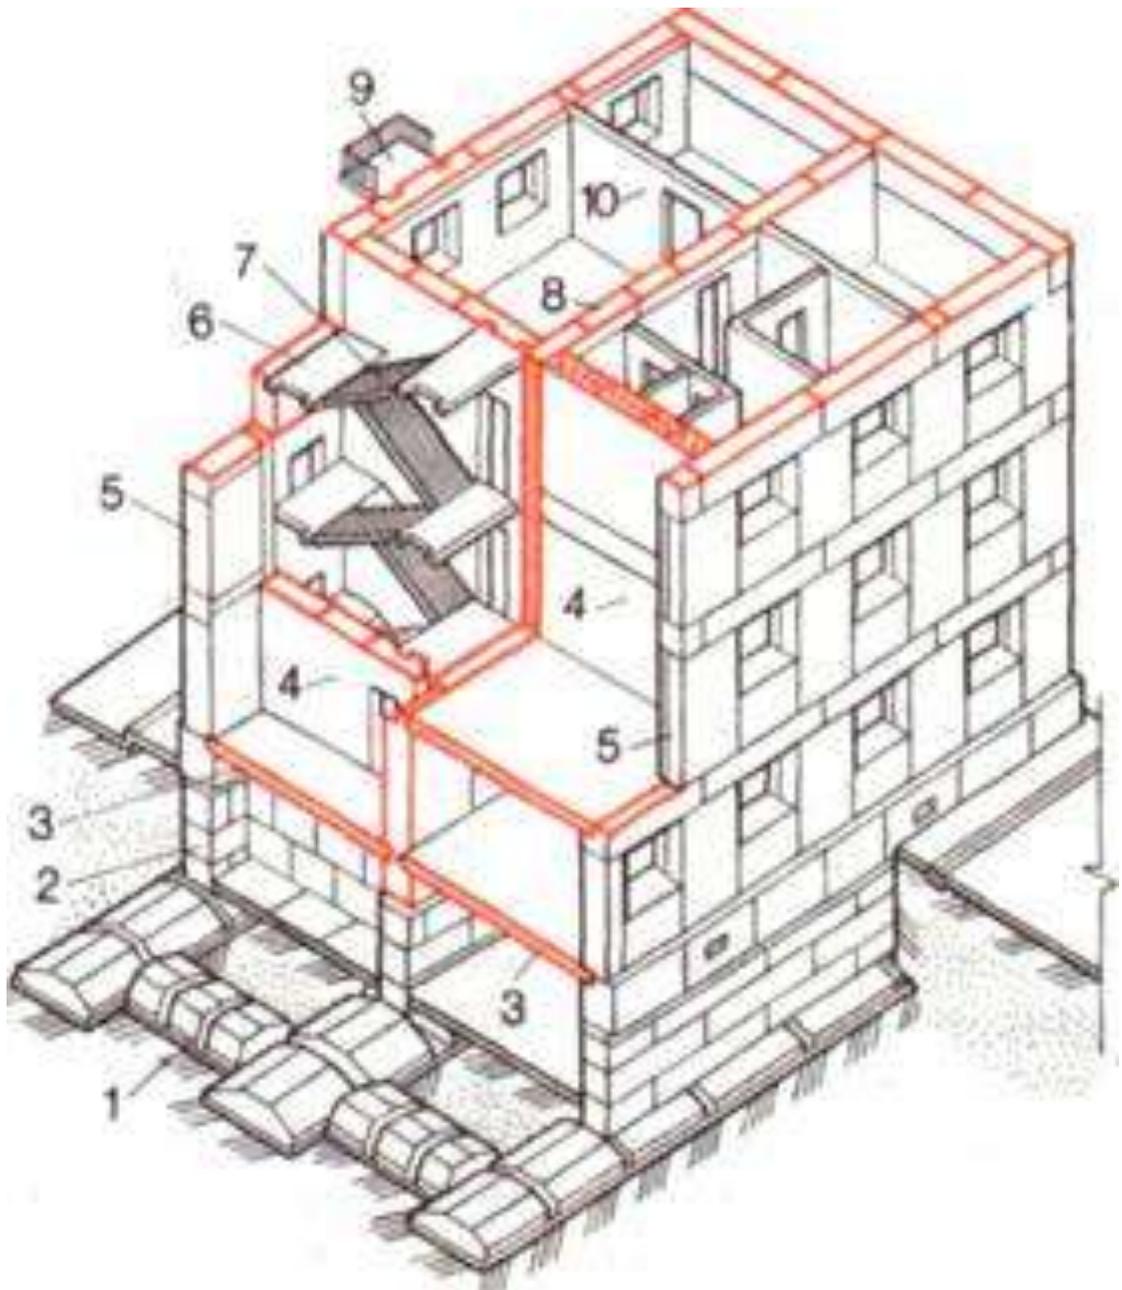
Конструктивная схема крупноблочного здания с продольными несущими стенами
